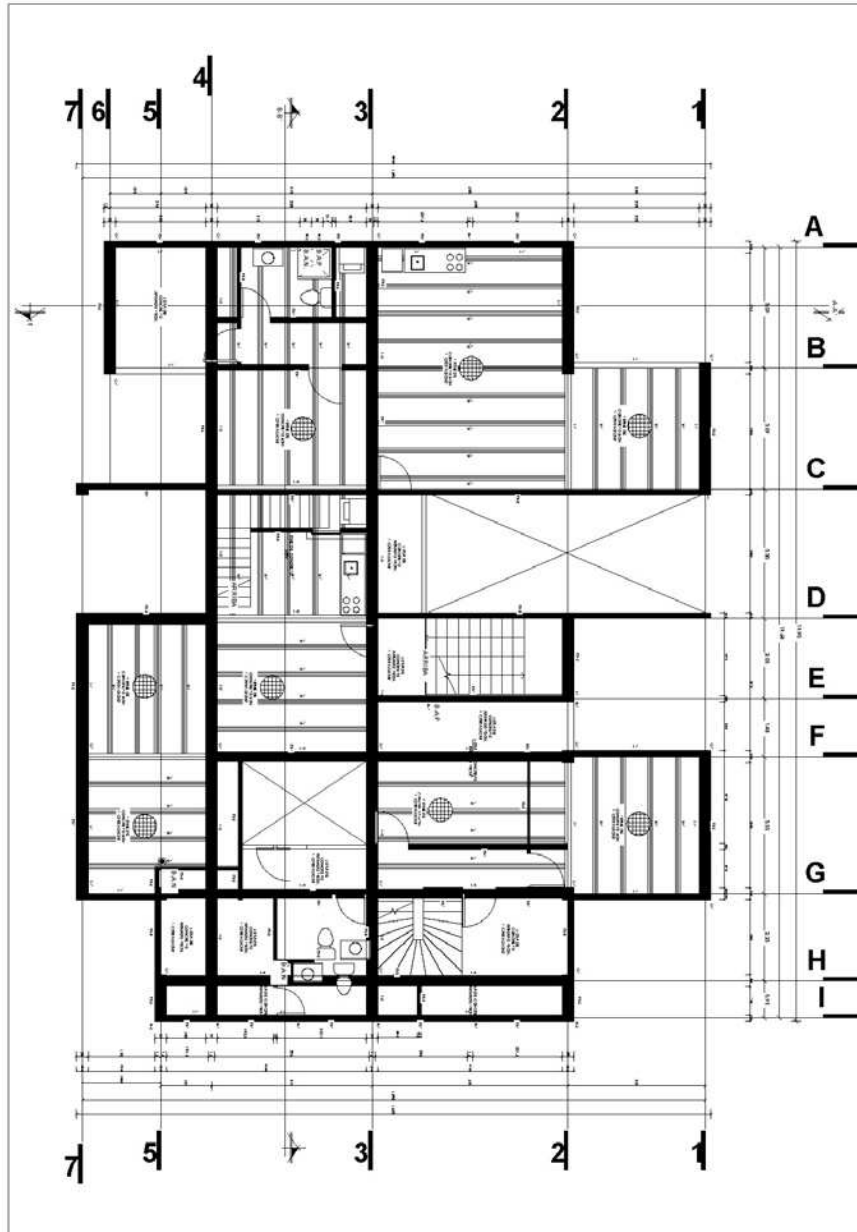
construcción de la planta baja de cada torre de departamentos del proyecto Villas Holx
